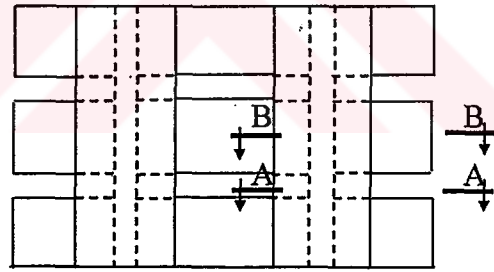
Betonarme kolonun perde duvara dönüştürülerek güçlendirilmesi
